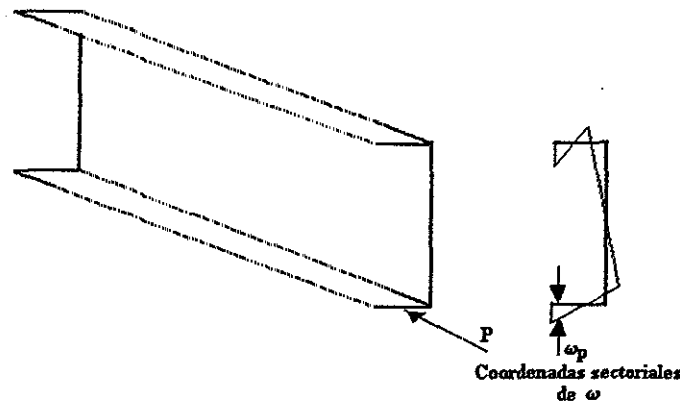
Fuerza P que actúa paralelamente al eje de la viga la cual causa un bimomento
